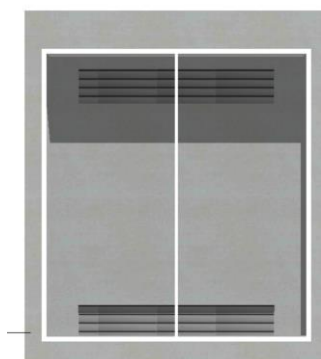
Aberturas de ventilação localizadas na parede acumuladora.
